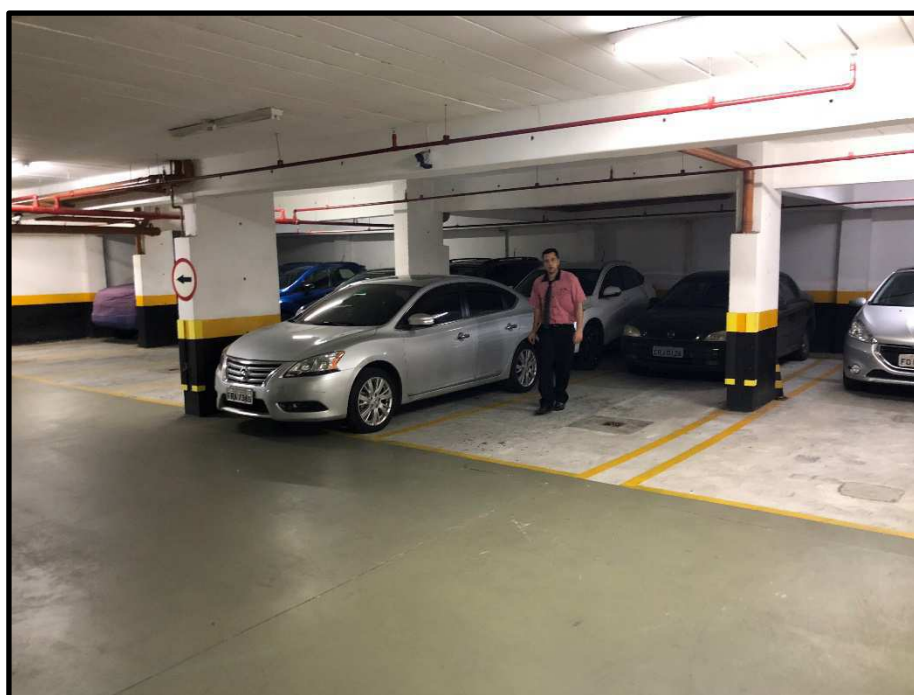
2º subsolo – vagas de garagem – Vista 1
